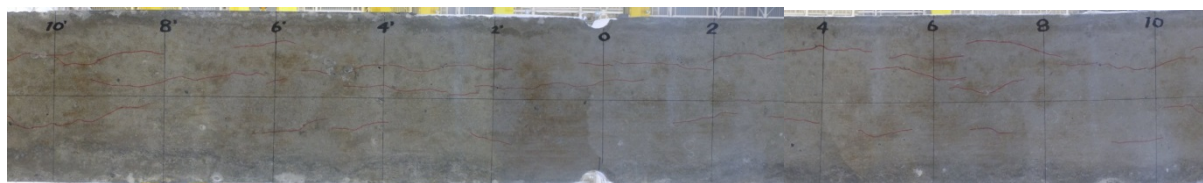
G6 桁桁下面ひび割れ状況 (桁中央から前後 1m の範囲)
